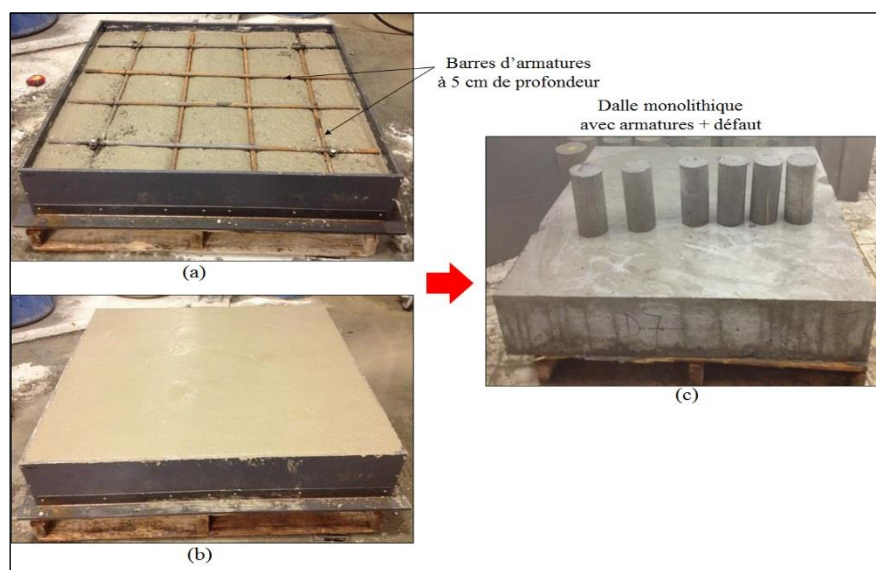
Dalle N° 7, (a) Remplissage du béton et mise en place des barres d'armature, (b) Remplissage du moule, (c) Dalle monolithique finale.
